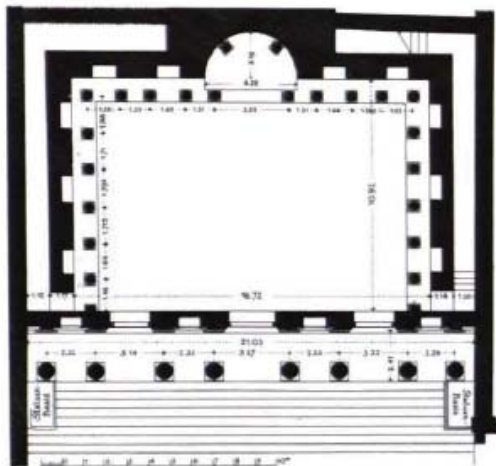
Celsus-Bibliothek, rekonstruierter Grundriss
